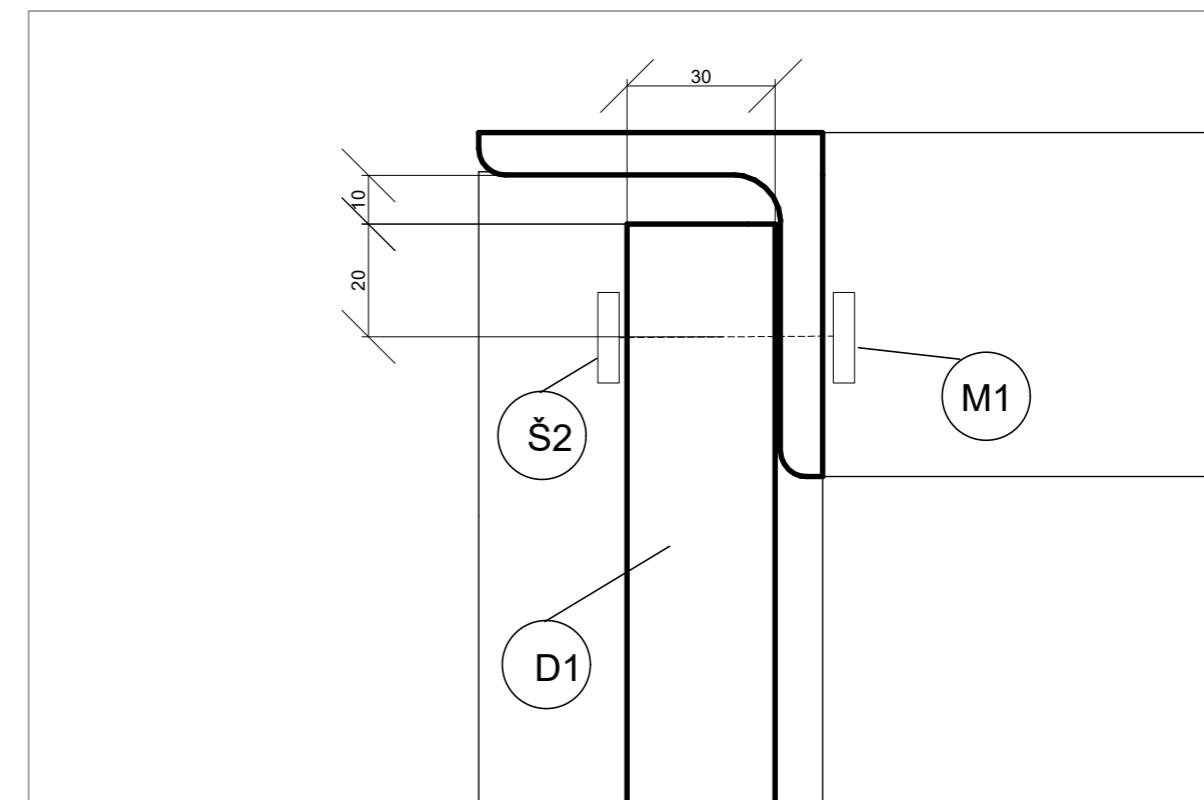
DETAIL UCHYCENÍ DŘEVENÝCH LATÍ M 1:2
